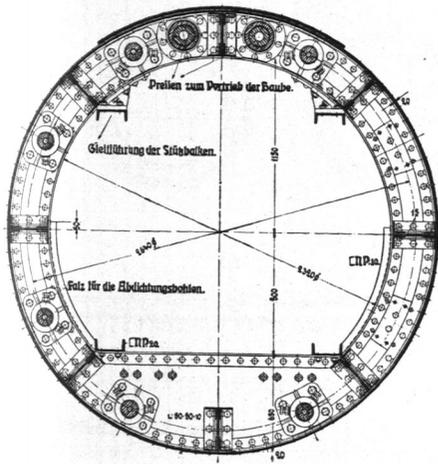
Tunnelstrecke der Bürgerweide, Brustschild, Querschnitt.
